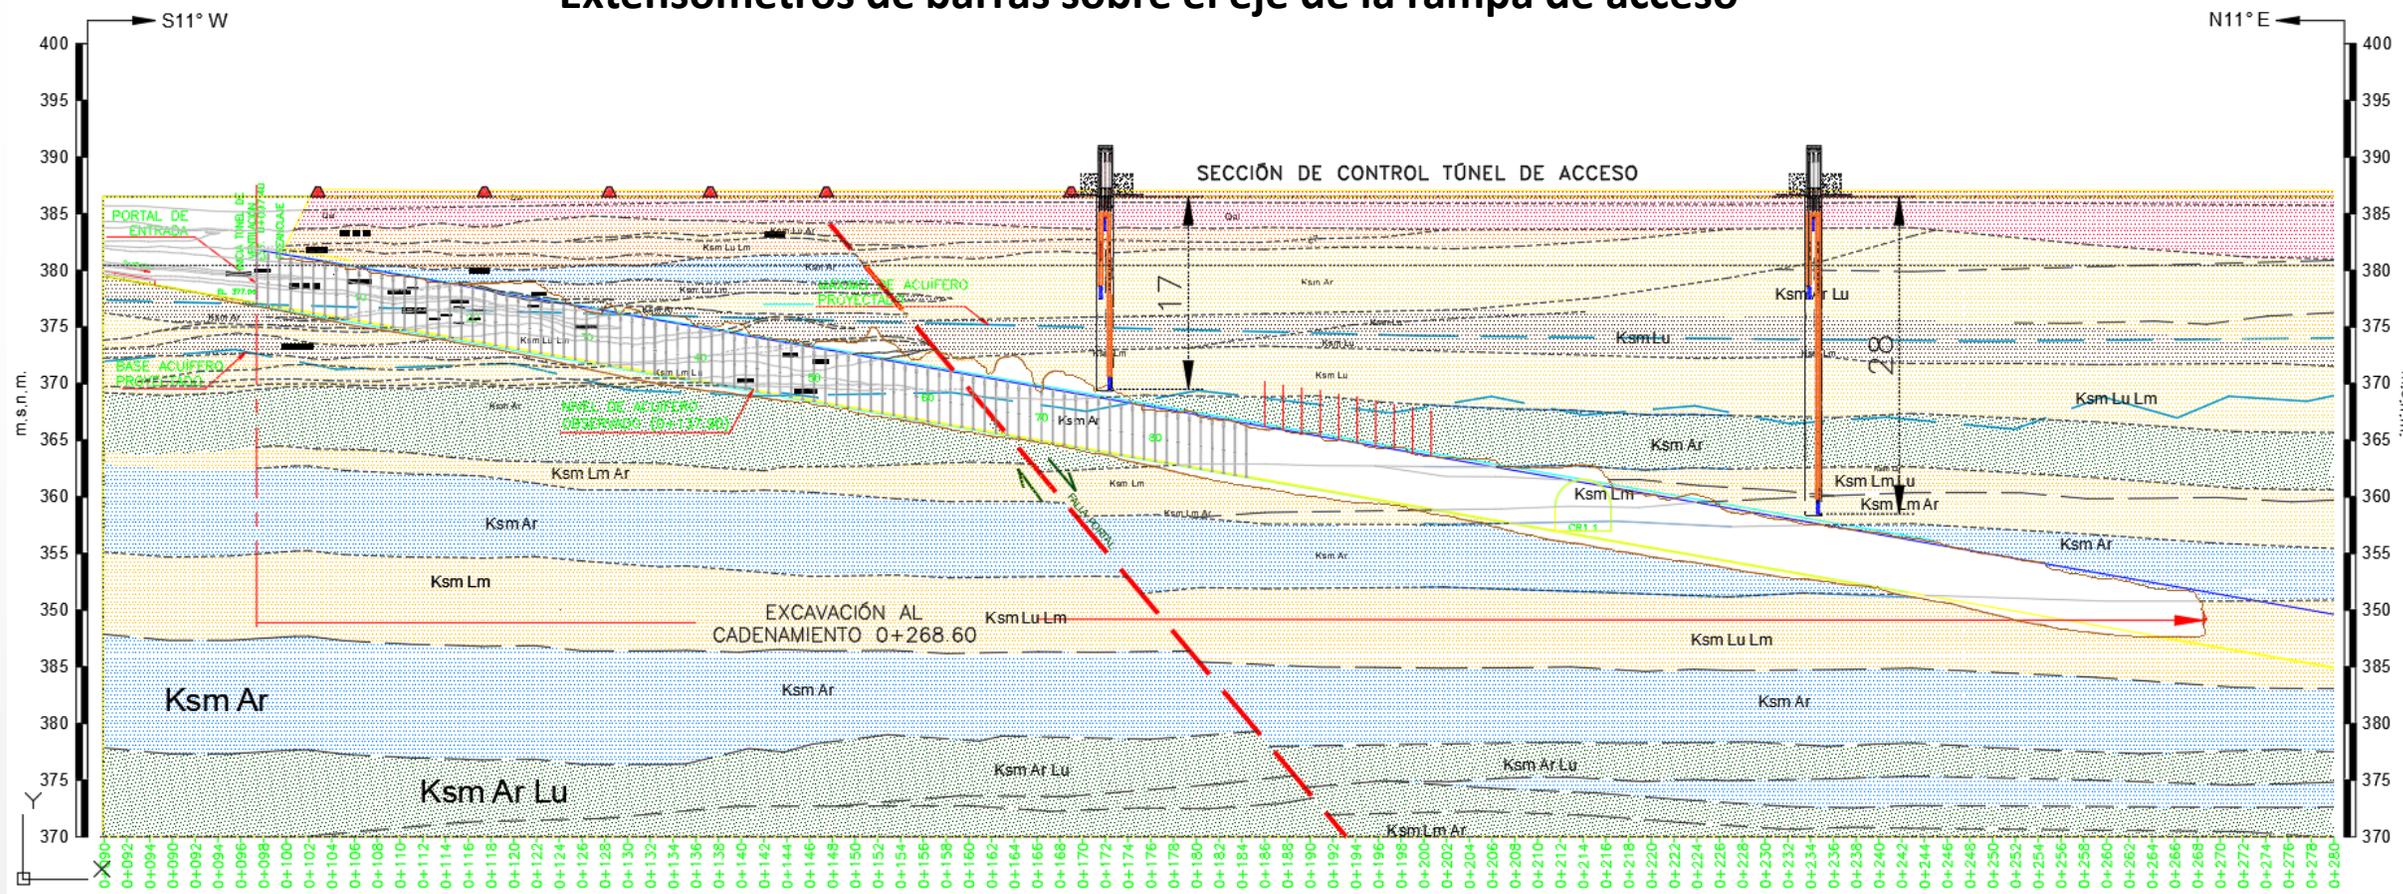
Extensómetros de barras sobre el cadenamiento 0+117 y 0+238
